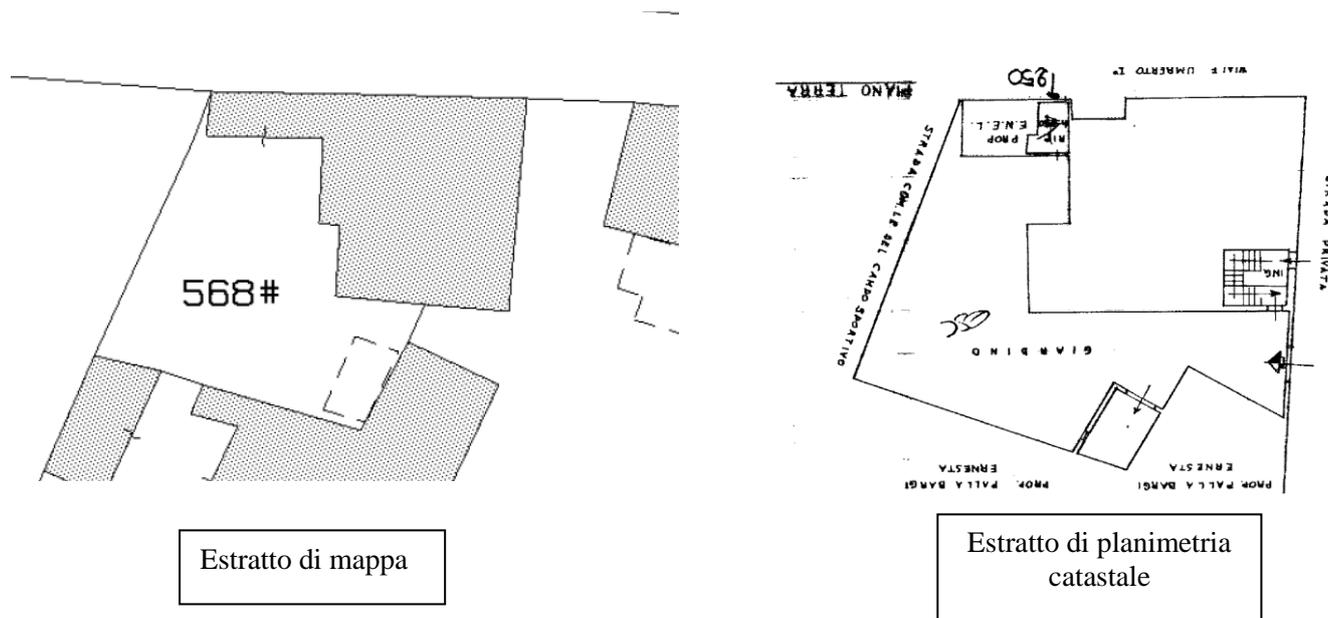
Estratto di mappa ed estratto di planimetria catastale
